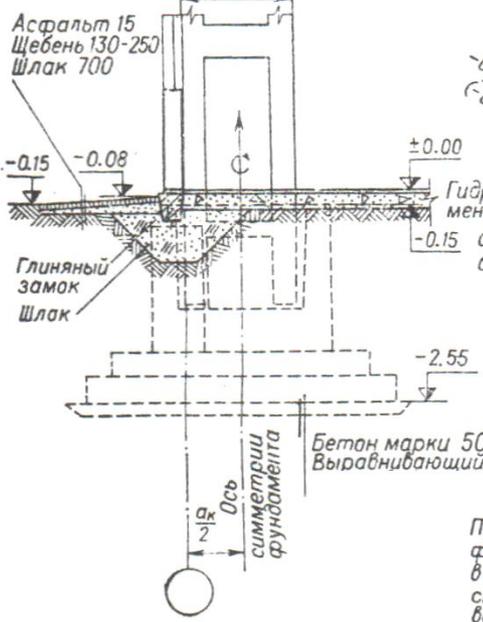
Составной железобетонный фундамент из сборных элементов.
